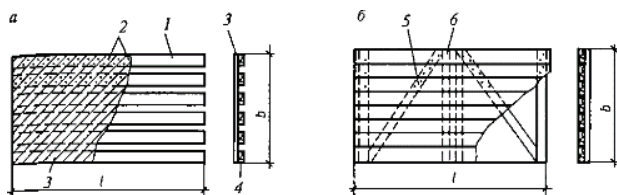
Дошгато - гвоздевые щиты настилов покрытий: а – щит двойного перекрестного настила; б – то же, однослойного раскосого настила; 1 – доски; 2 – гвозди; 3 – косой защитный настил; 4 – разреженный рабочий настил; 5 – раскосы; 6 – поперечины.
